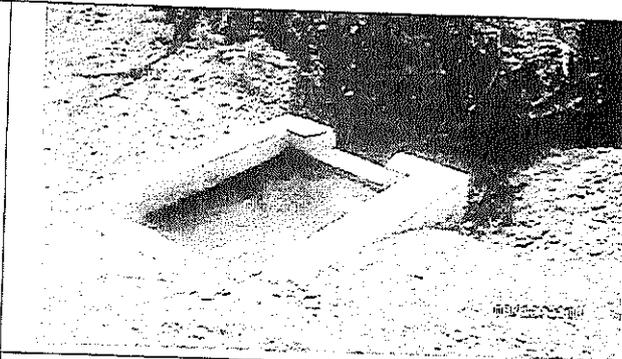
Construção de saída de água a jusante, tanto o ladrão quanto a derivação foram construídas caixas de concreto (alvenaria).
